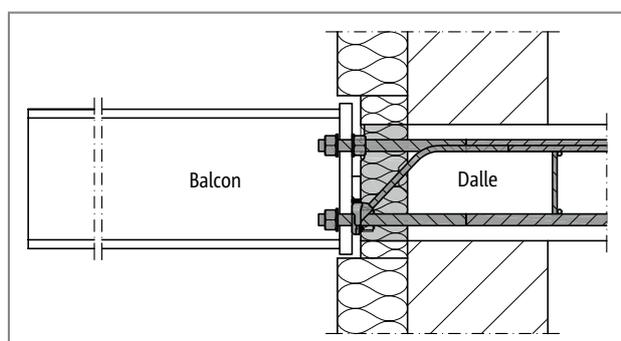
Schöck Isokorb® T type SK : Raccordement à la dalle en béton ; corps isolant à l'intérieur de l'isolation externe
